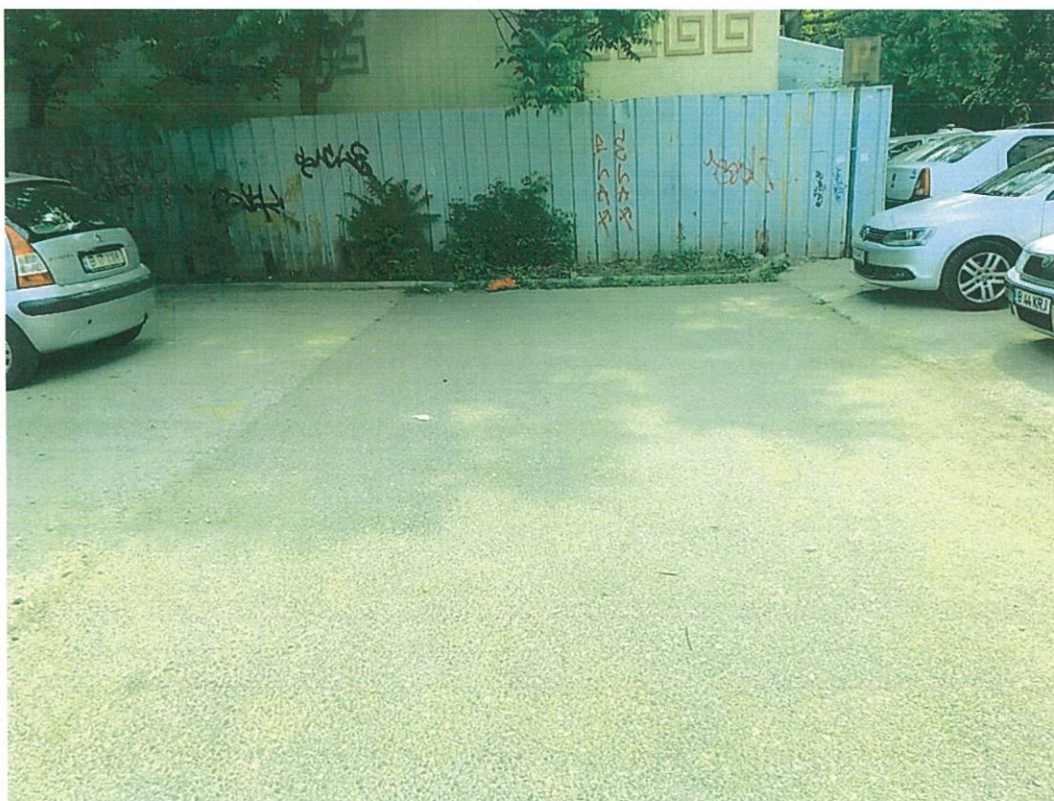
Intre Str. Sapanta si Str. Padureni
